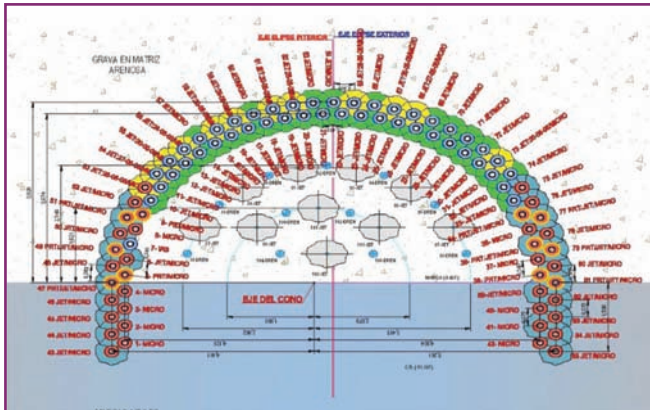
Sección del paraguas de protección e impermeabilización. Plano de seguimiento
